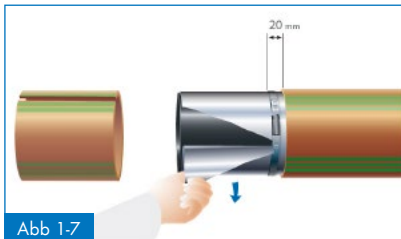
Entfernen des Aluminiummantels mit Hilfe einer Schlauchschelle
